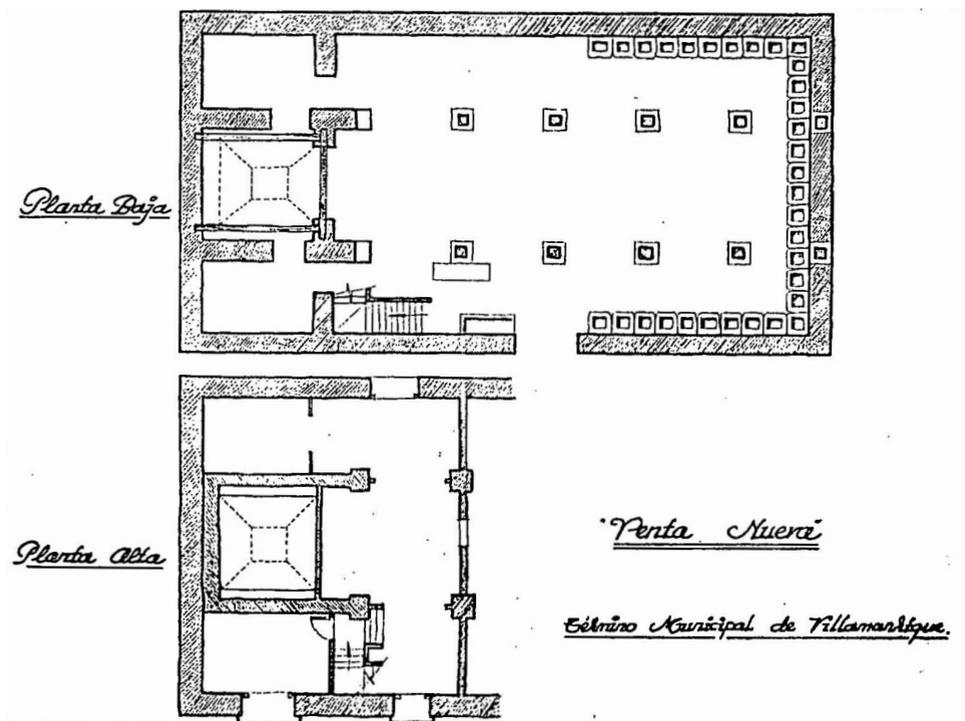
Planta baja y alta de Venta Nueva. Fuente: Prieto, López y Corchado (1971: 178.v).
